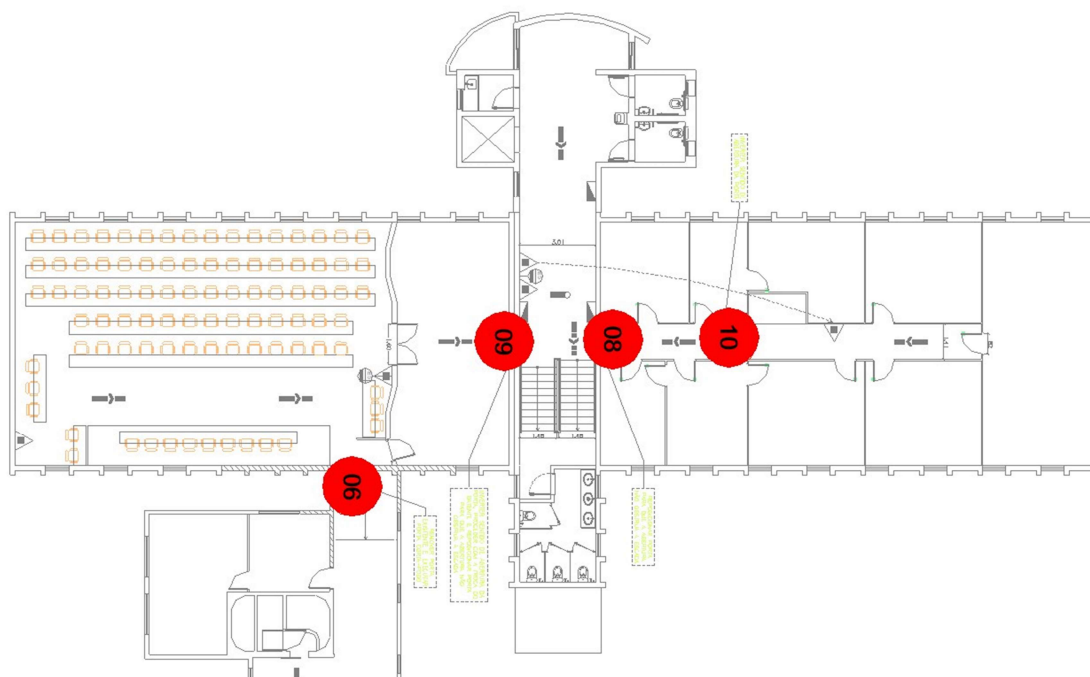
Planta 1º pavimento Prédio da PG/SG/Consu
